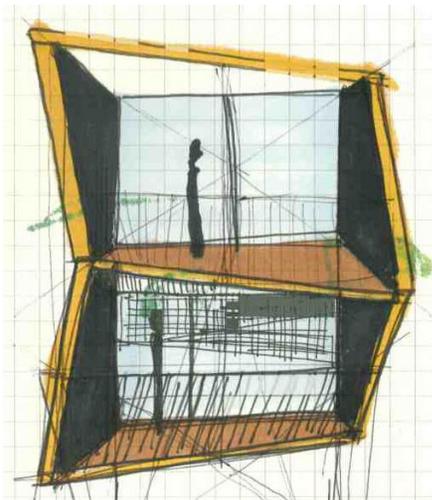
Esquema de Planta de Conjunto y Perspectiva
